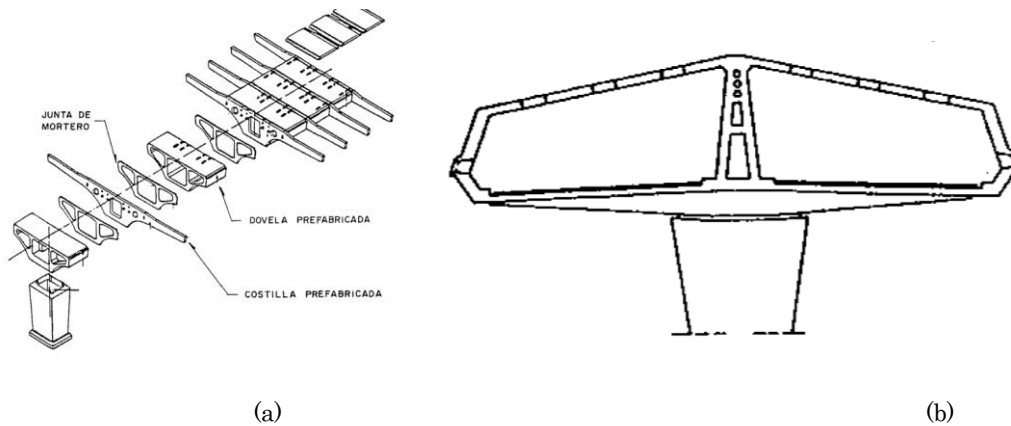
a) Viga cajón compuesta por dovelas y costillas prefabricadas. b) Viga cajón cerrada (Fuente:[1]).
